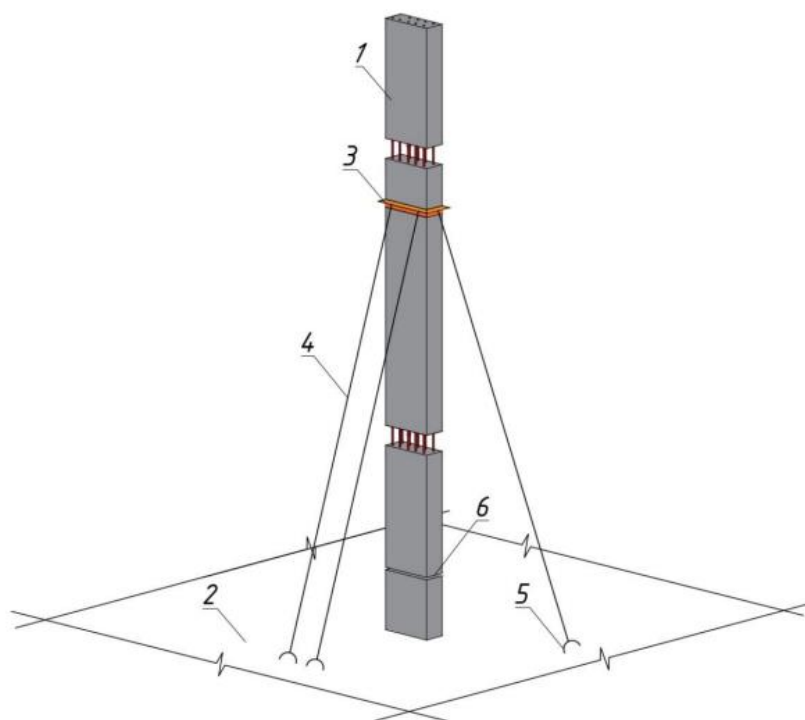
Схема монтажного закрепления элемента колонны подкосами 1 – верхняя секция пилона; 2 – ж/б перекрытие нижележащего этажа; 3 – металлический хомут – монтажная обойма с проушинами для крепления подкосов; 4 – инвентарный металлический винтовой подкос; 5 – анкеры для крепления нижней части монтажных подкосов, закрепленные на перекрытии; 6 – стык нижнего и верхнего элемента пилона (штепсельное соединение)
